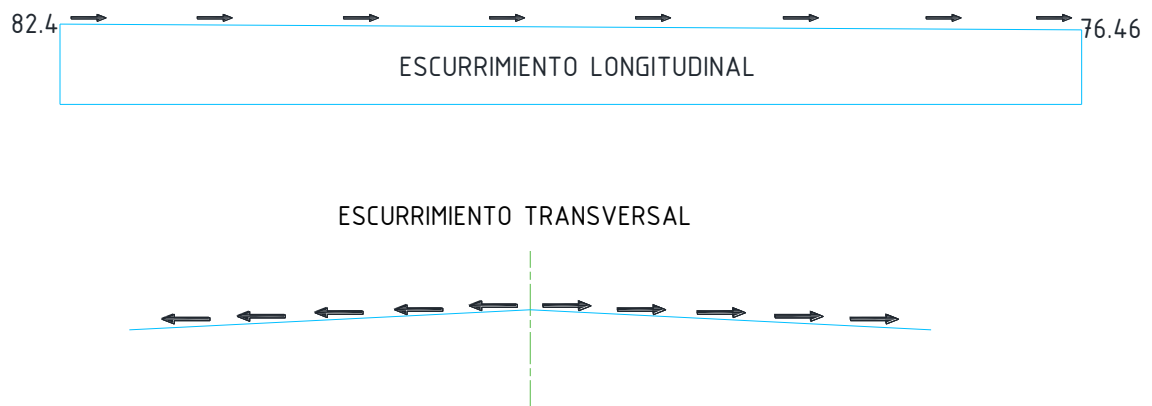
Escurrimiento longitudinal y transversal de la pista
